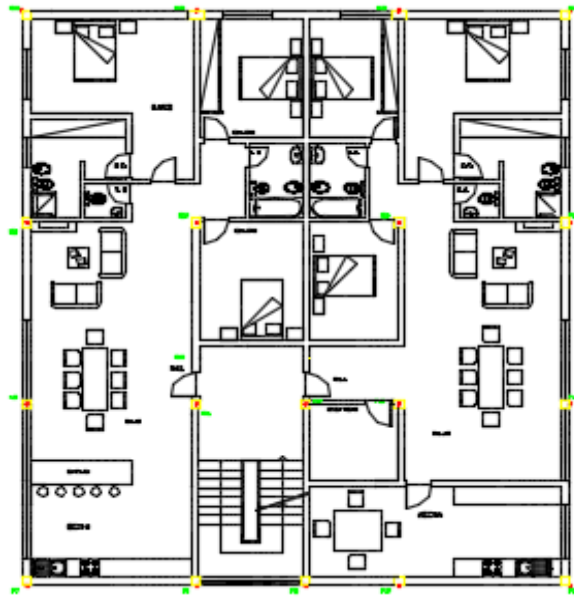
Planta baixa de estudo deste trabalho. (Fonte: Software Autocad).
